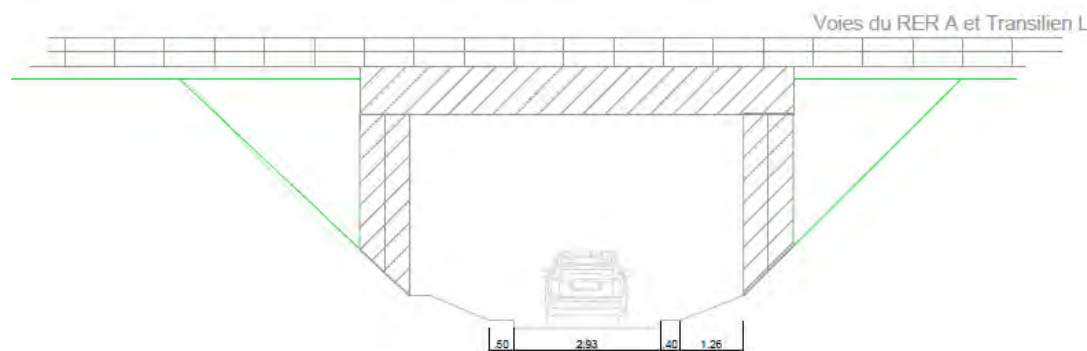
Coupe type du pont-rail d'Achères Ville existant
